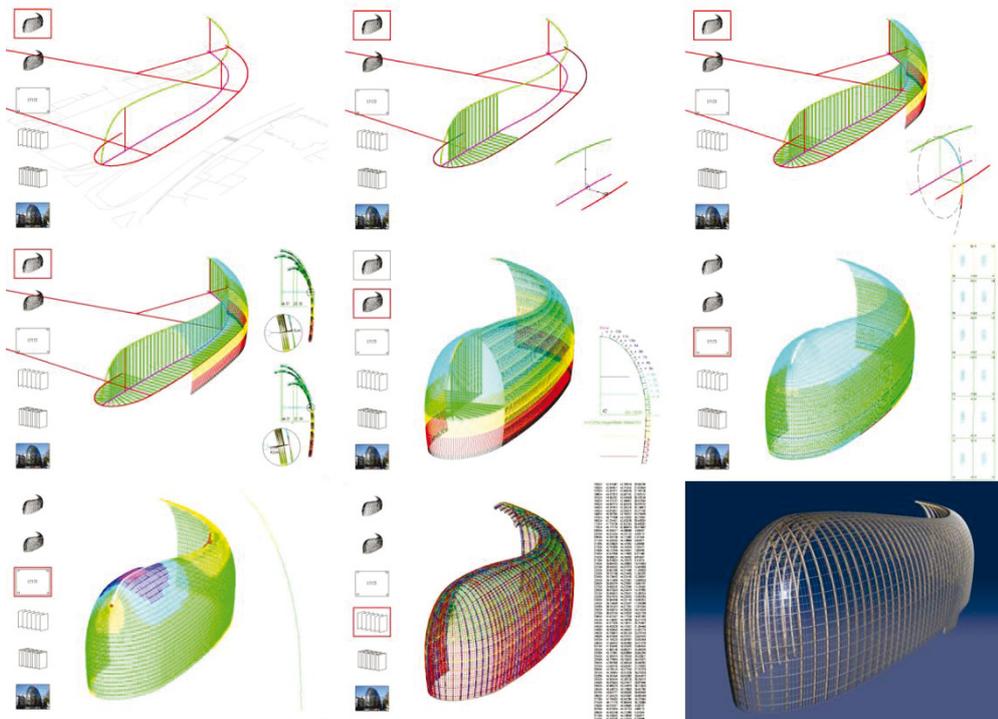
Screenshots des Skripts: 1. Designkurven; 2. Generierung der vertikalen Ebenen; 3. Vertikale Fassadenschnitte; 4. Detail Anbindung an Stockwerksplatten; 5. vertikale Fassadenteilung; 6. Horizontale Fassadenteilung/ verwundene Glasflächen; 7. Übersicht Fassadenteilung, ebene Glasflächen; 8. Daten für die statische Berechnung; 9. Rendering des detaillierten Modells
